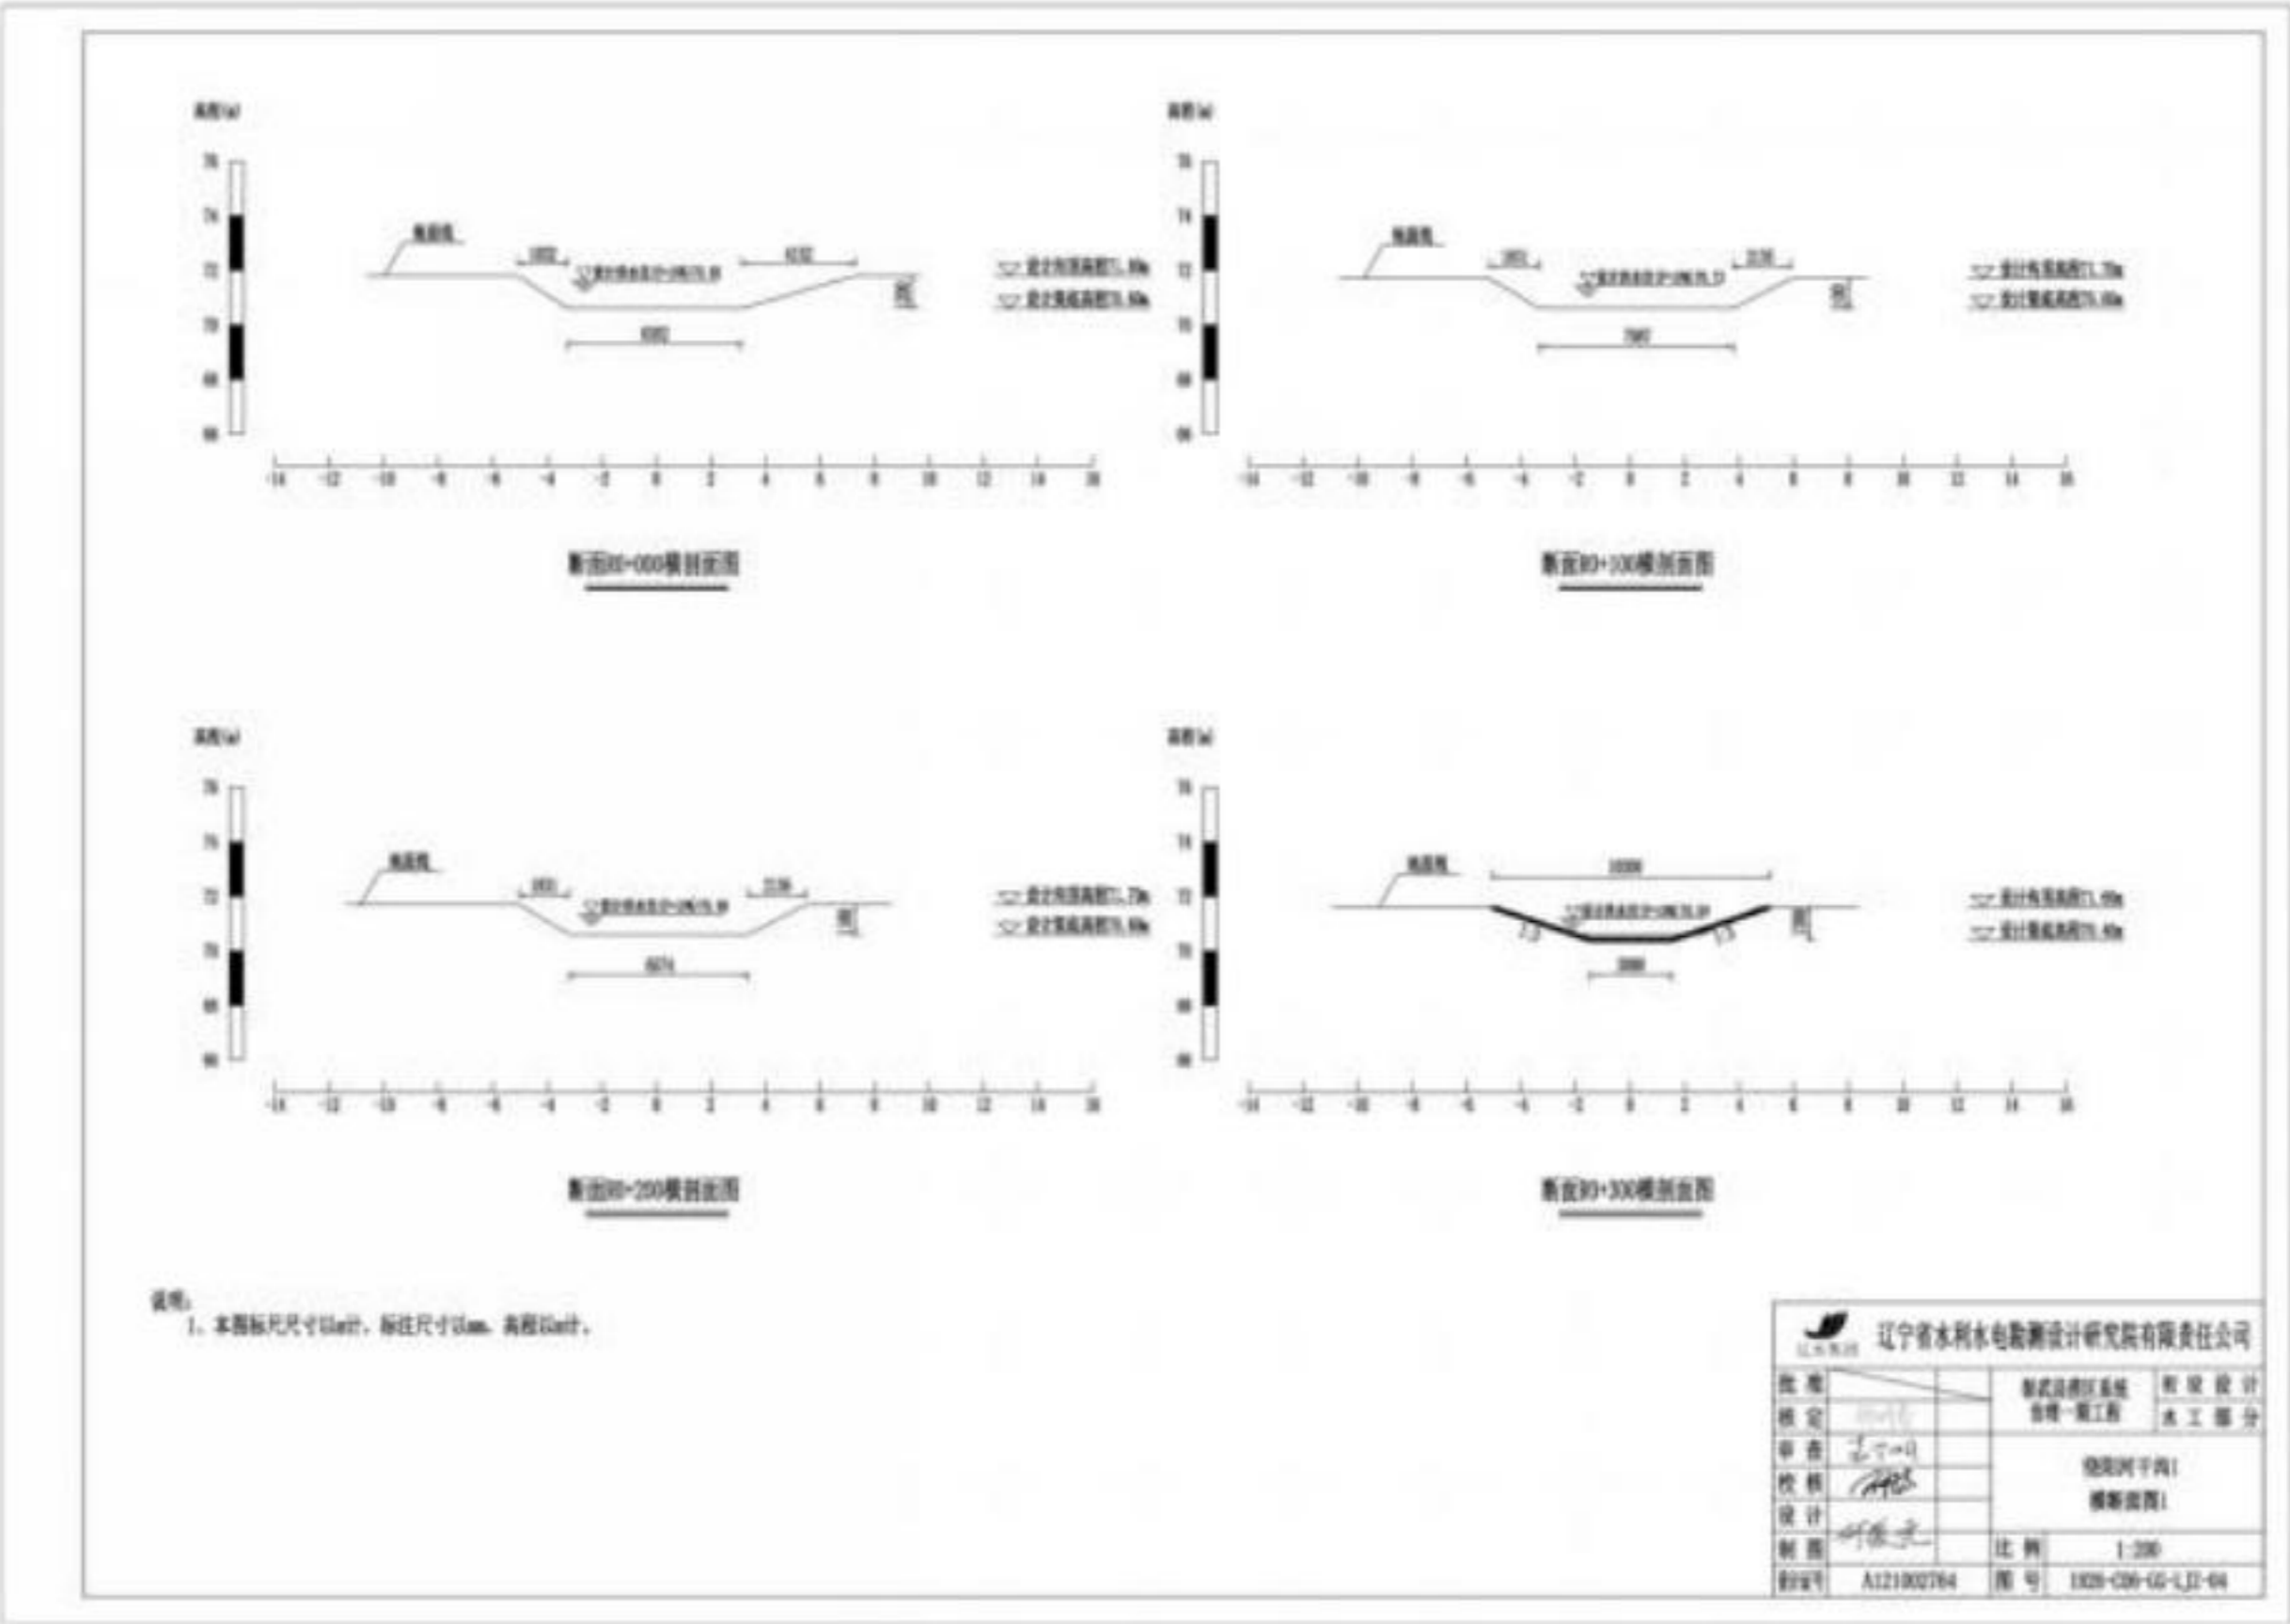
(1) 两家子镇绕阳河干沟 1 剖面图
